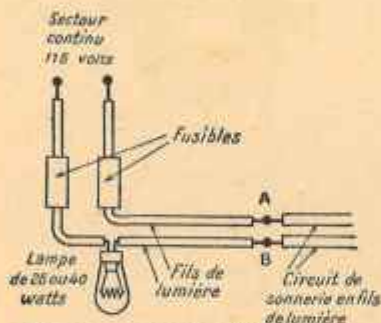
Montage d'une sonnerie sur le secteur continu.
